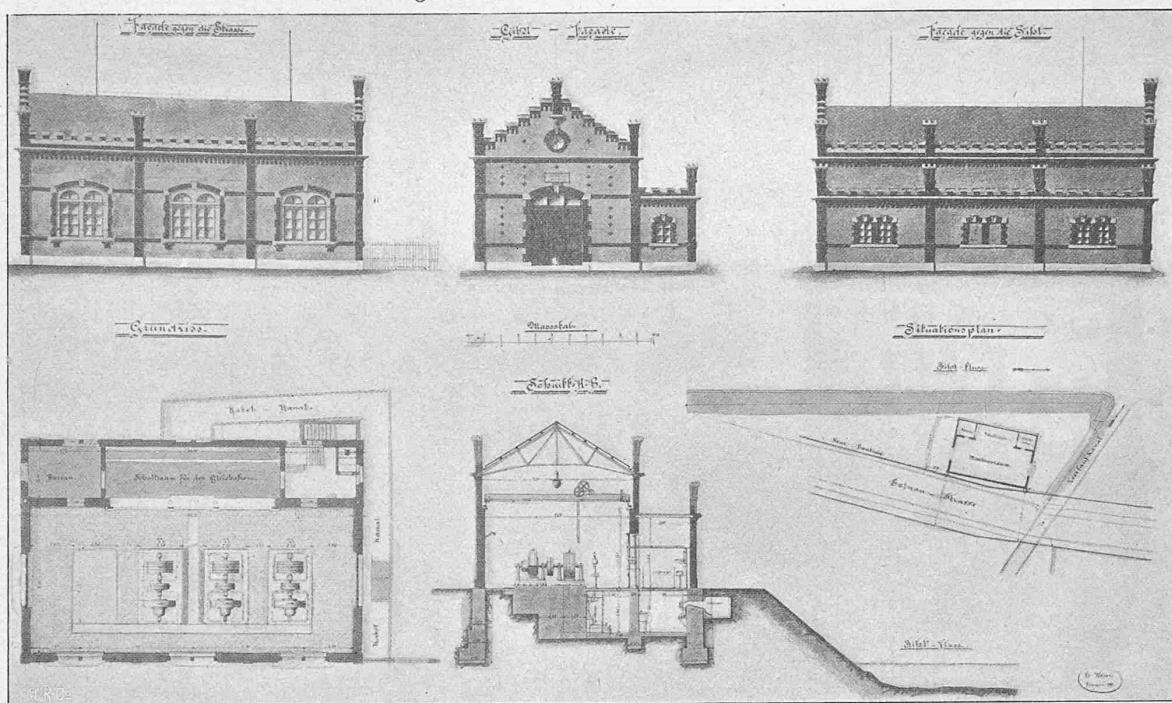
Umformerstation. — Lageplan, Grundriss, Fassaden und Querschnitt 1:400.
